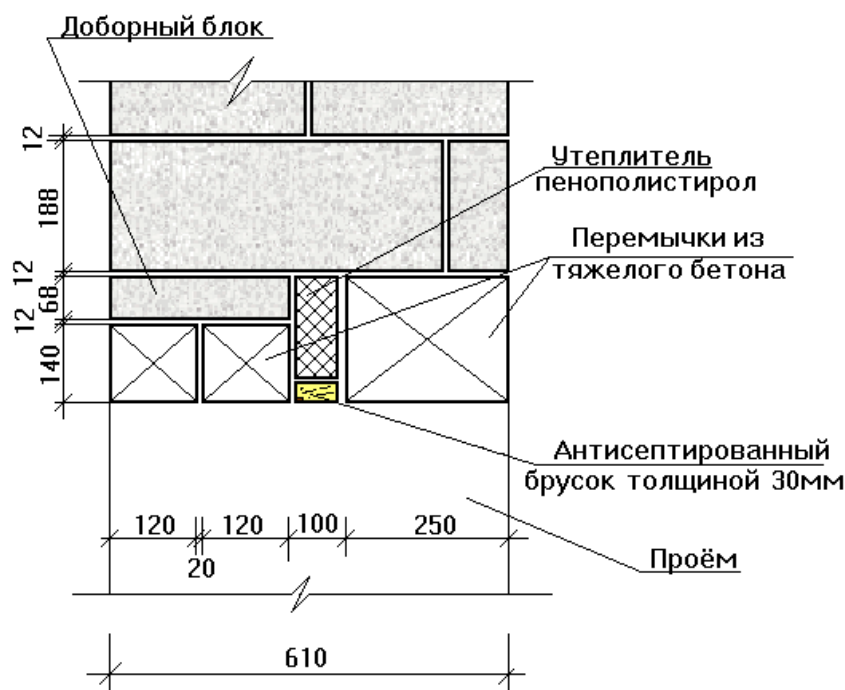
Пример выполнения проёма в наружной стене толщиной 610мм с использованием перемычек из тяжелого бетона.
